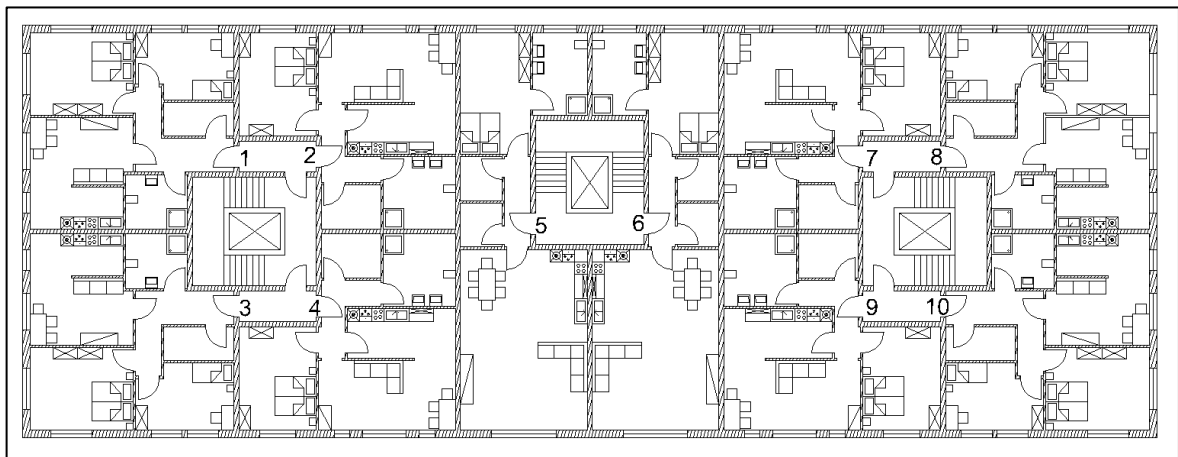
Grundriss eines Regelgeschosses (ohne Maßstab)
